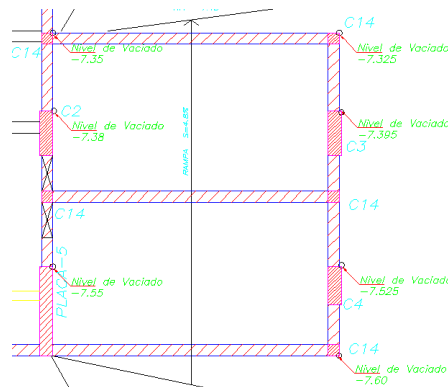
Nivel de Vaciado de muros de concreto.
